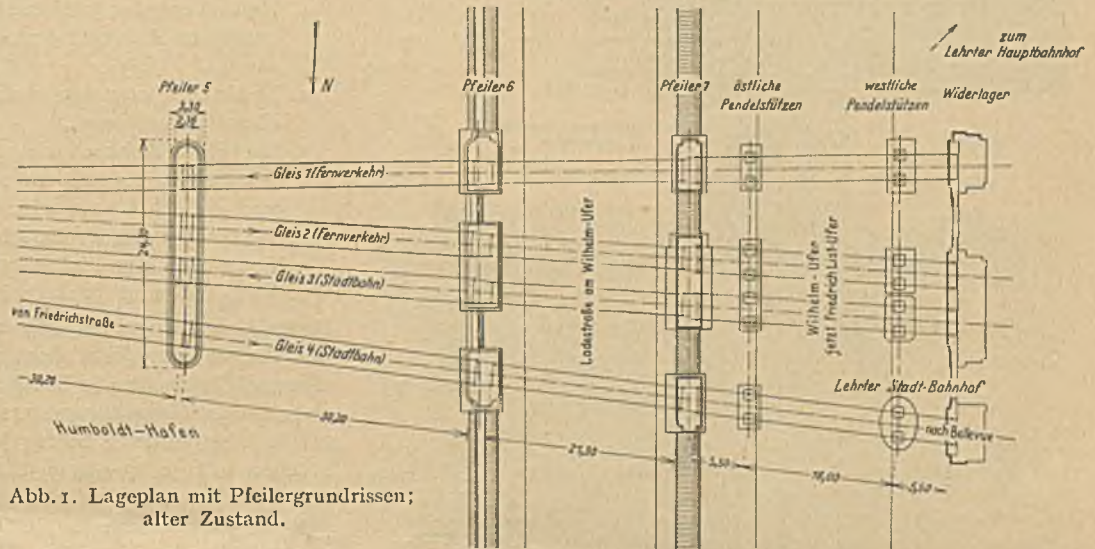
Lageplan mit Pfeilergrundrissen; alter Zustand.
